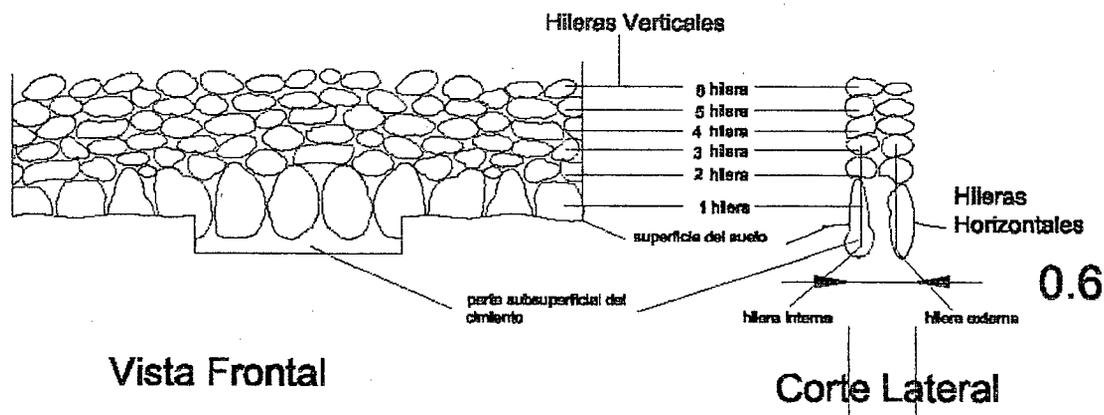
Esquema de un muro donde se detallan las posibles ubicaciones de los materiales.
